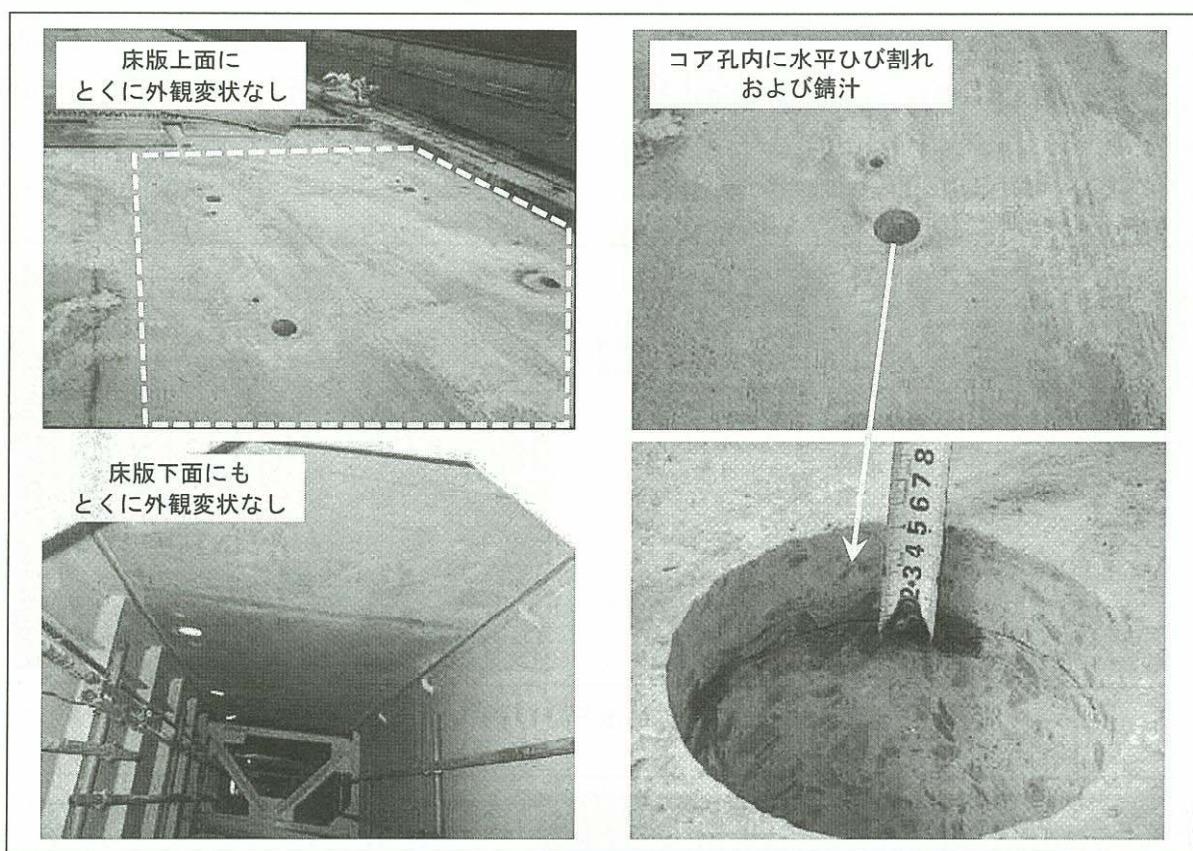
打音法で検出できない水平ひび割れ（G橋の撤去床版）
